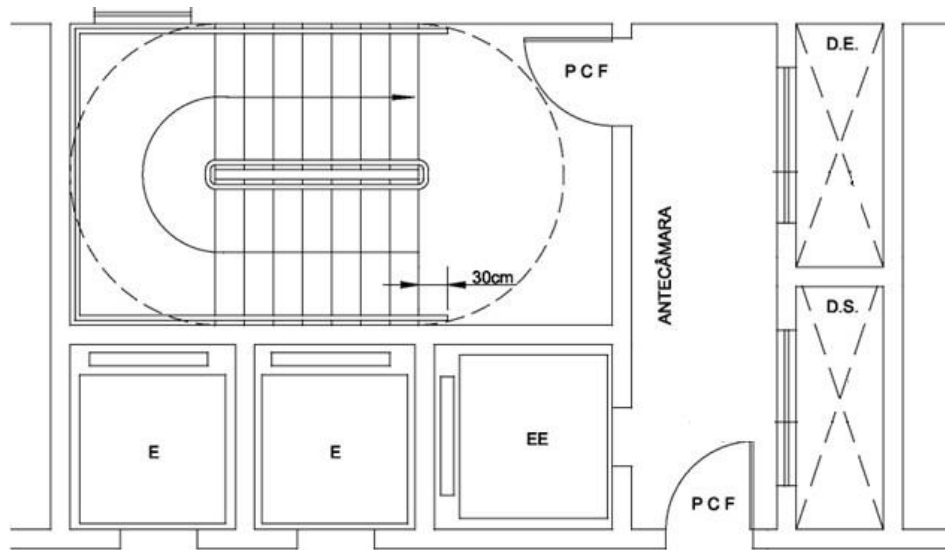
Escada enclausurada à prova de fumaça com elevador de emergência (a posição deste é somente exemplificativa) na antecâmara
